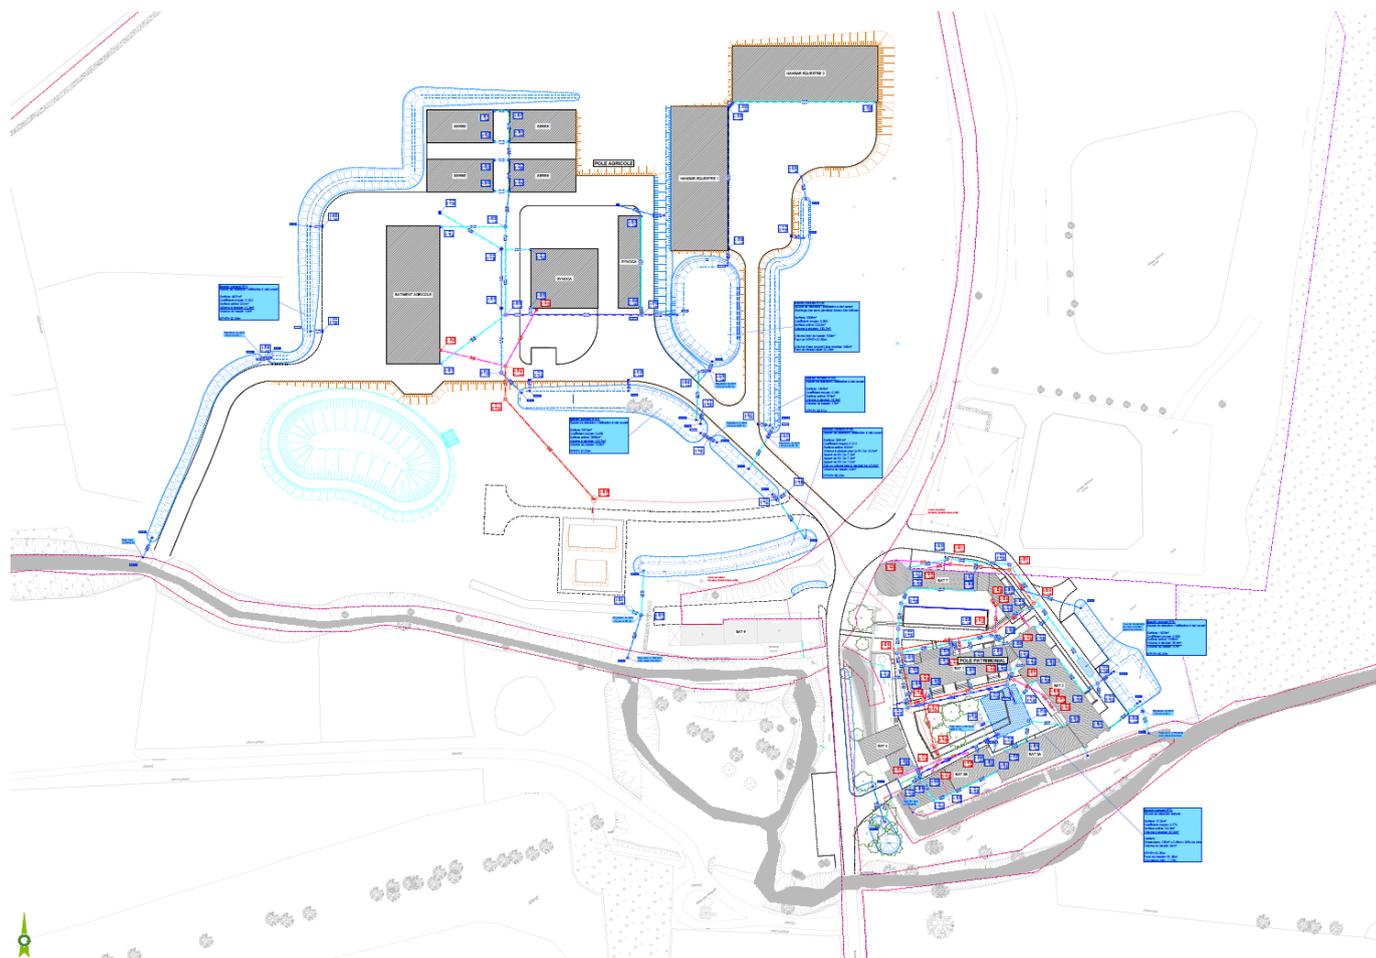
Extrait du plan d'assainissement global du projet - Source : Orling
